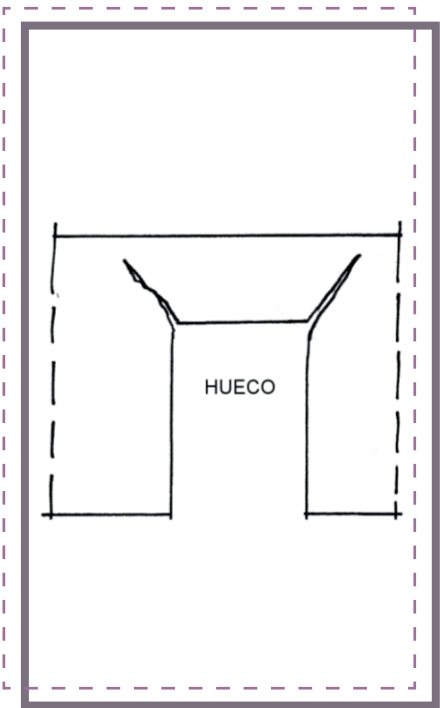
Esquema de fisuras por asentamiento plástico en muro de hormigón armado.
